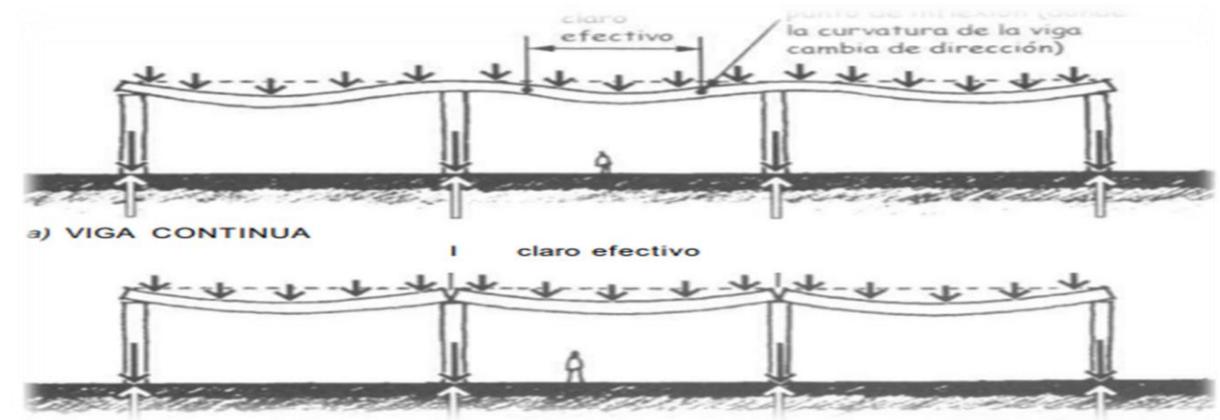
Comparación de Vigas de igual tamaño. Fuente: Fuller Moore, 1999.
